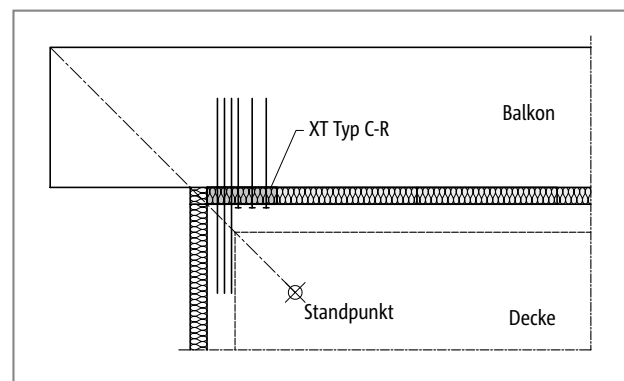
Schöck Isokorb® XT Typ C: Balkon über Gebäudeecke auskragend (Einsatz XT Typ C-R)
